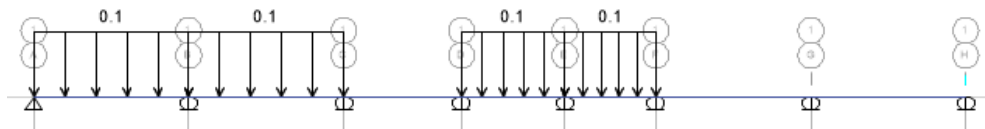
Carga viva distribuida en vigueta de losa aligerada – Damero 3
